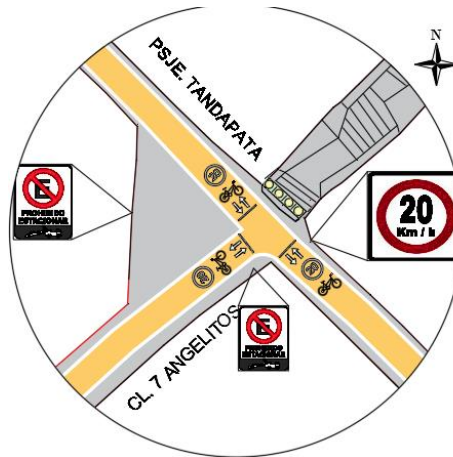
Propuesta en planta de 7 Angelitos con Tandapata
